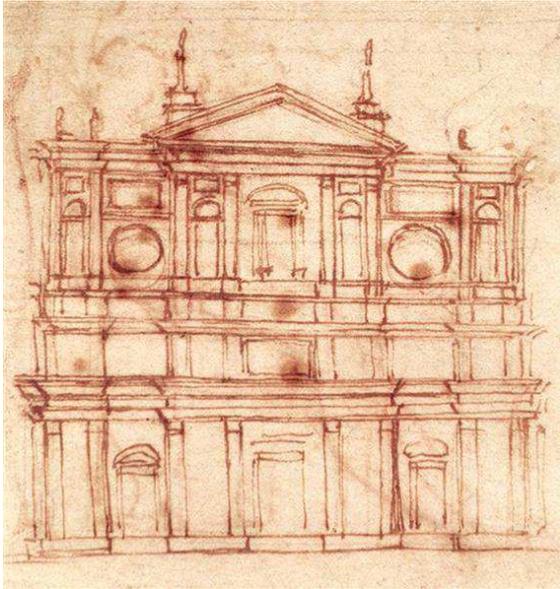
San Lorenzo, fachada. Florença, Itália. Michelangelo, 1517.
